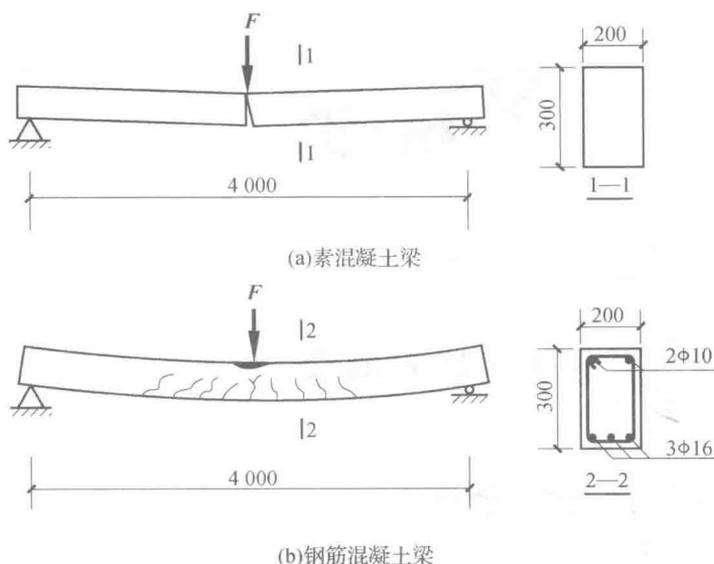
钢筋混凝土梁与素混凝土梁的破坏情况比较
